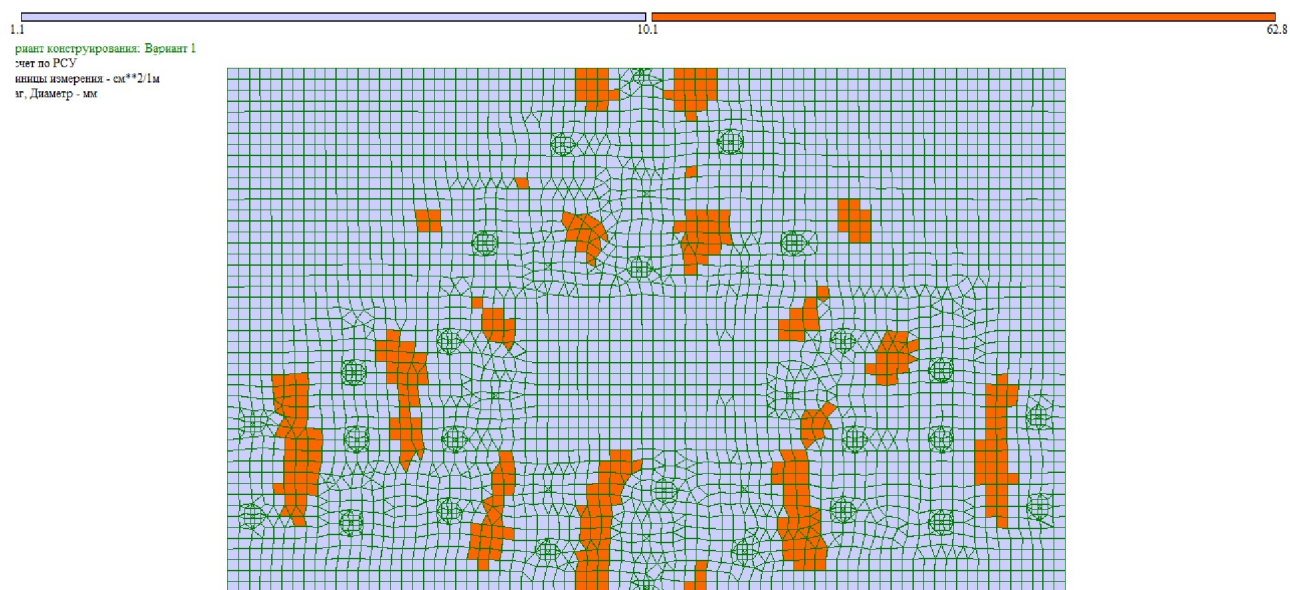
Армування фундаментної плити (Верхня по X)
